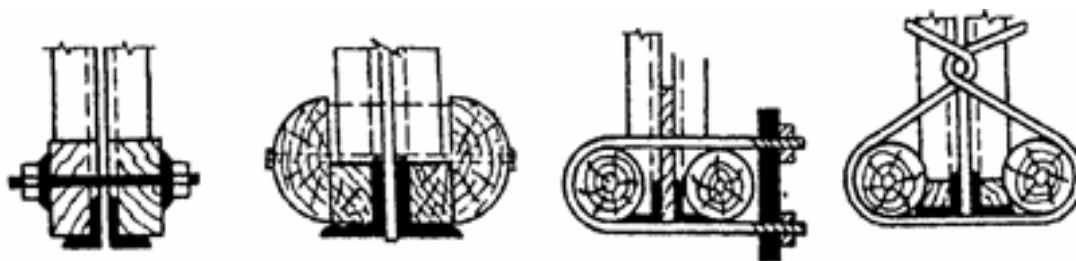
Схемы временного усиления нижнего пояса фермы брусом
